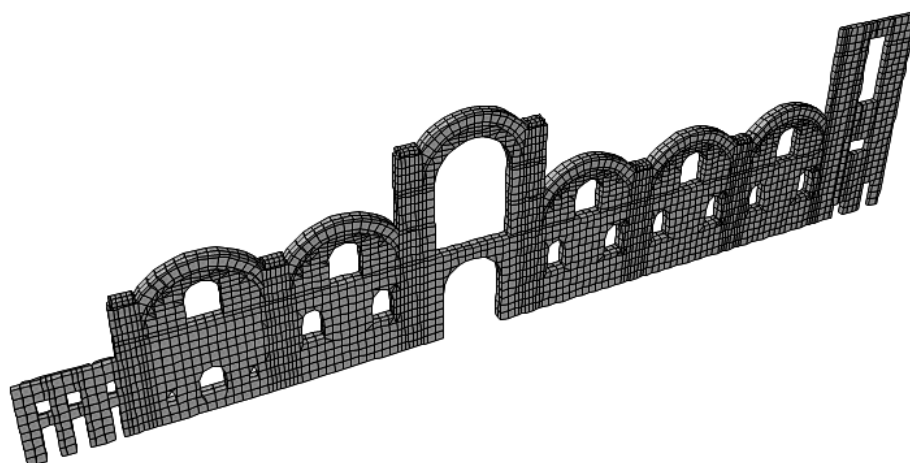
Muro transversal en SAP 2000. Fachada Sur.
